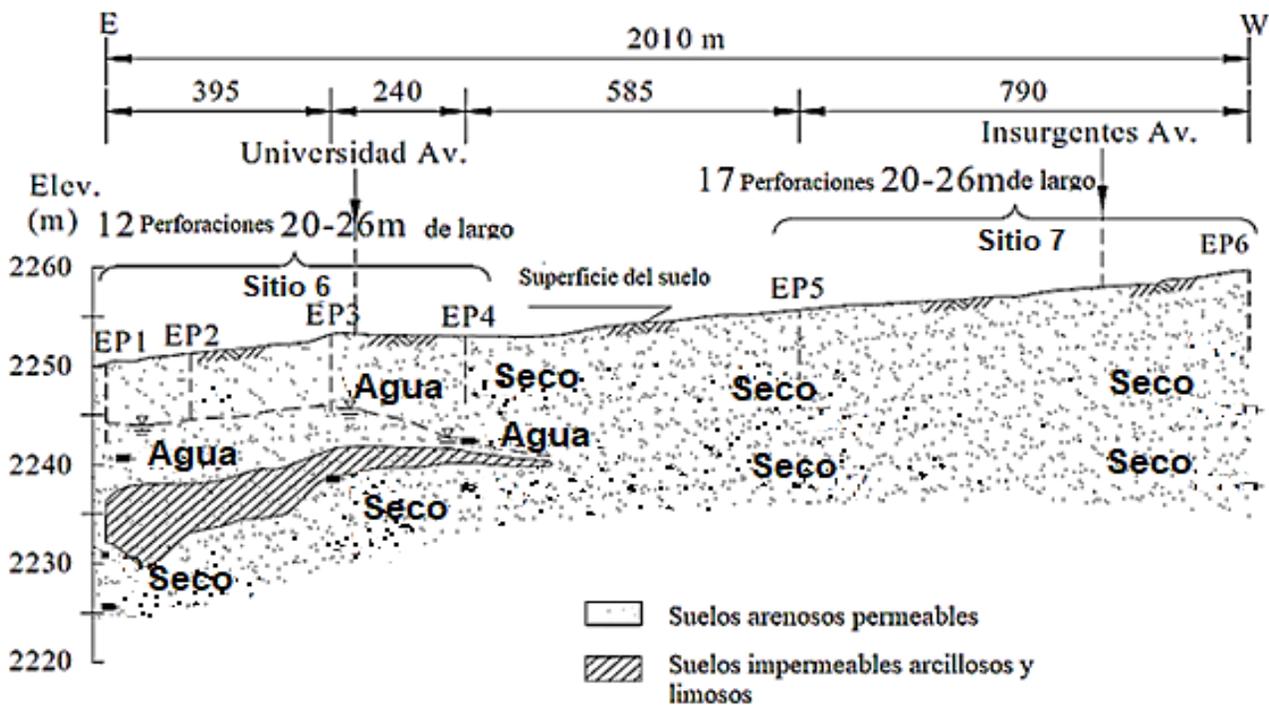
Perfil longitudinal en zonas de transición¹¹
